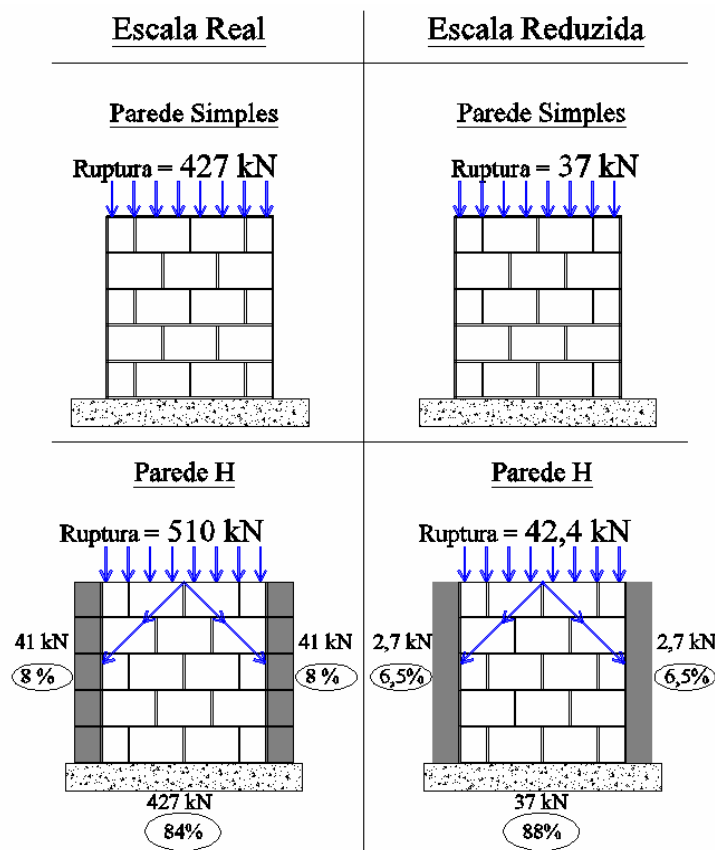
Relação entre Cargas de ruptura de parede simples e painéis H
